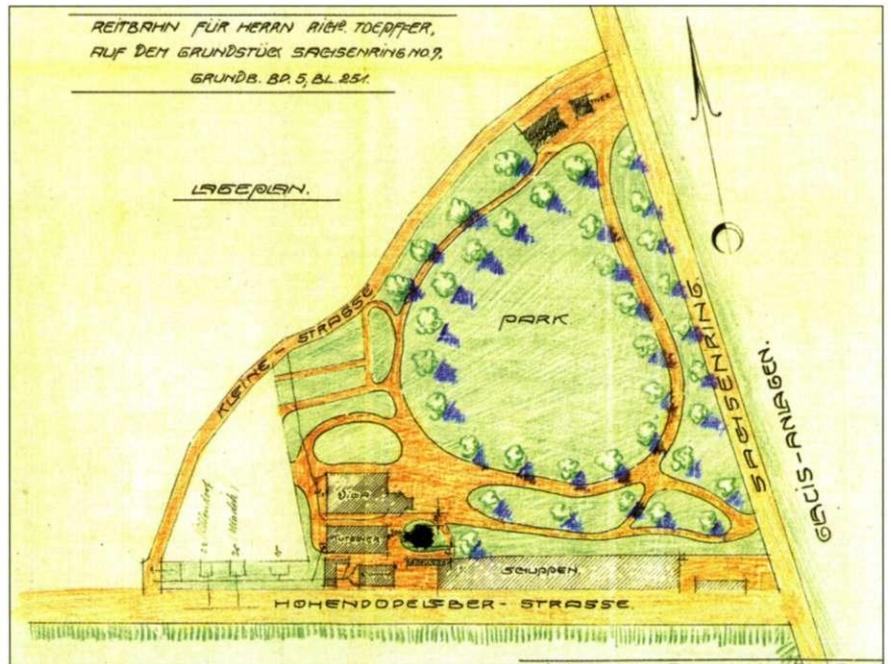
Liebknechtstraße 14, Lageplan des Grundstückes aus dem Jahr 1910
